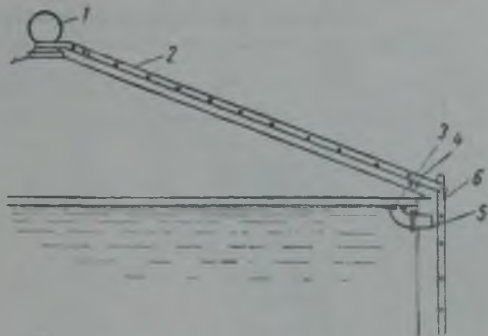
Вращающаяся лестница для водонапорного резервуара
